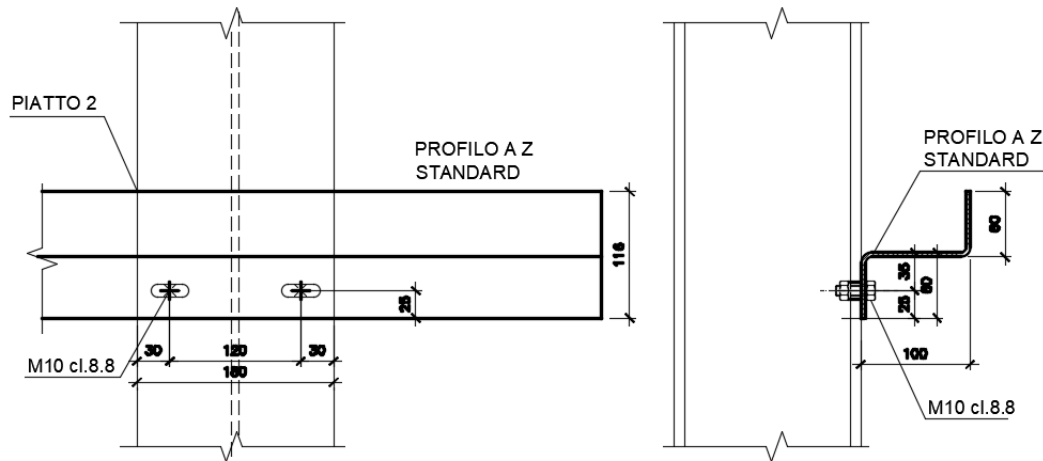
Dettaglio collegamento Z 100x60x4mm nel tratto a sbalzo
